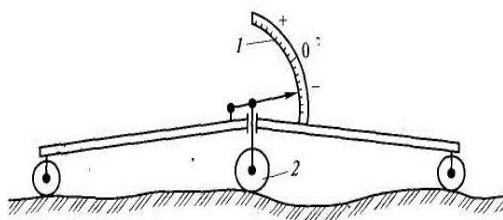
Передвижная двухопорная рейка ПКР-1 [57, 62]:
